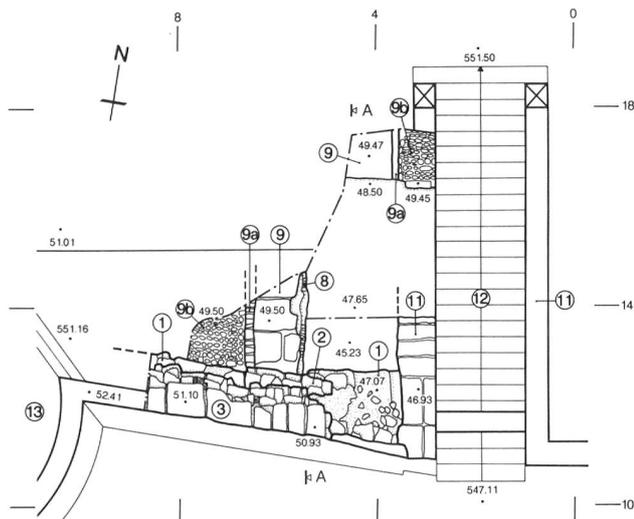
Burgdorf, Grabenstrasse. Grundriss M. 1:150. Legende siehe auch Abb. 257. 9a Zwischenwände westlich und östlich an Sandsteinplattenboden, 9b Pflasterungen in den angrenzenden Räumen, 11 Treppwangen, 12 aktuelle Treppe, 13 Ziegelturn.
